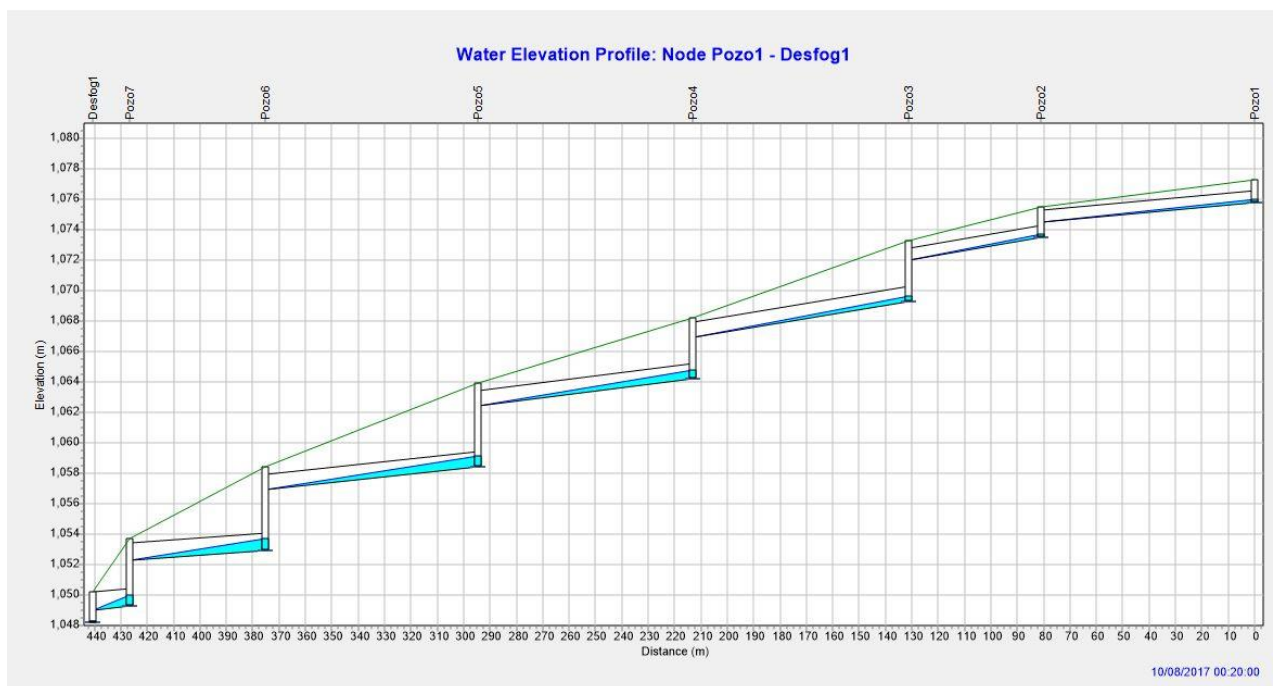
Perfil de modelo del sistema de alcantarillado pluvial correspondiente al Tramo 5.
